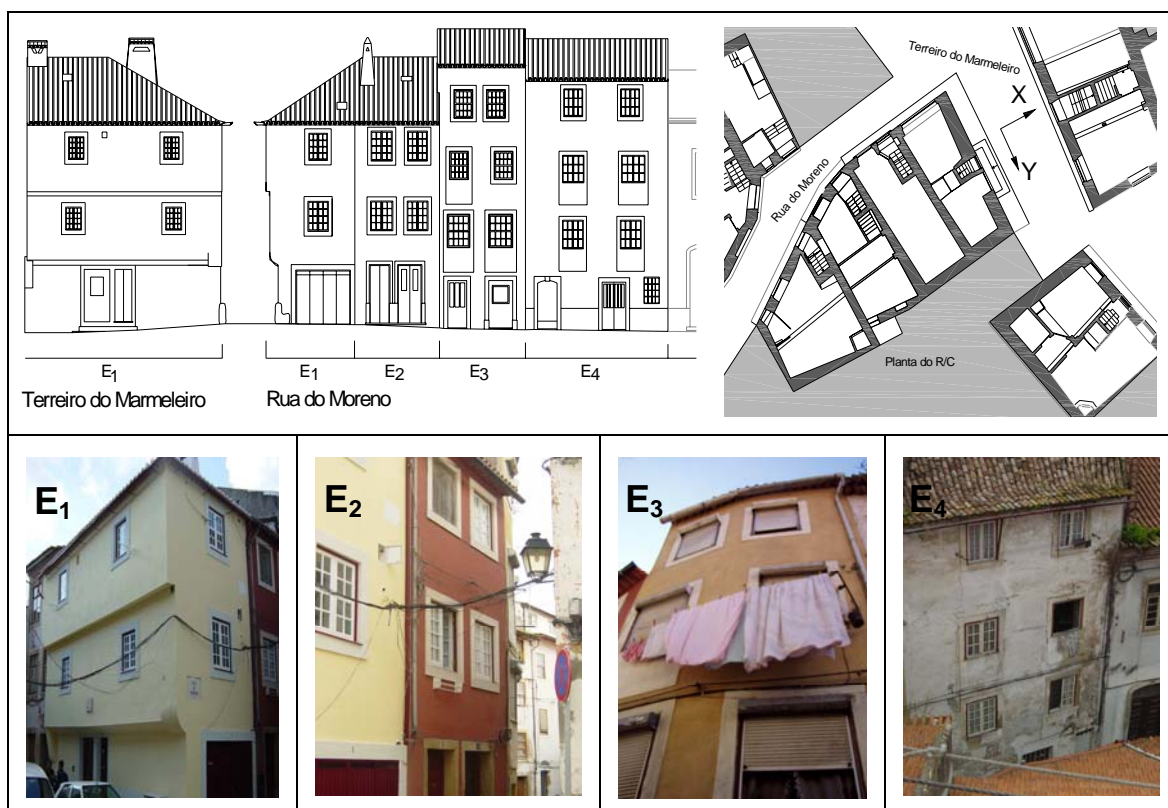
Alçados, planta do rés-do-chão e fachadas dos quatro edifícios
